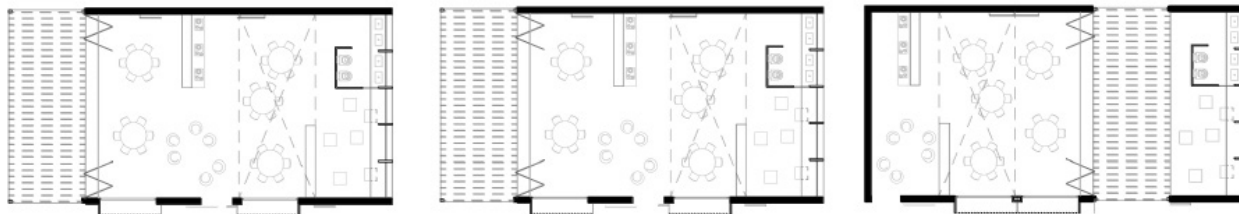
Planta del Módulo Tipo. Fuente: Elaboración propia.
